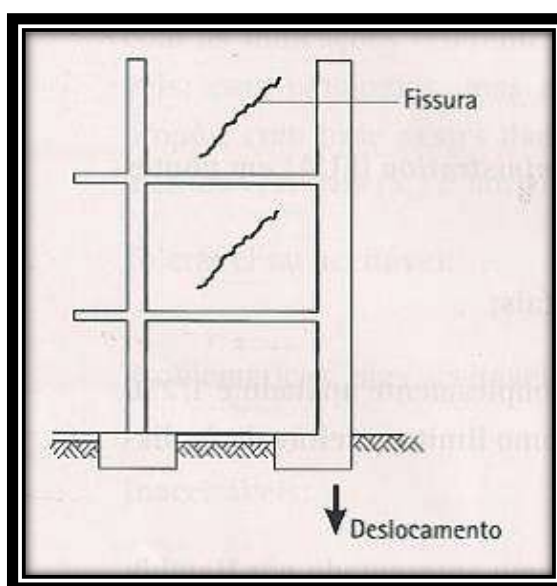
Fissuras por recalque de fundação de pilar de canto
